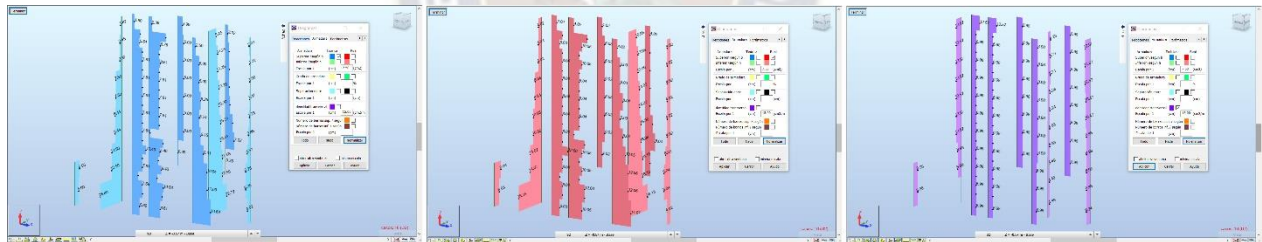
Áreas de armadura teórica, real y de cortante - Fuente: Elaboración propia
